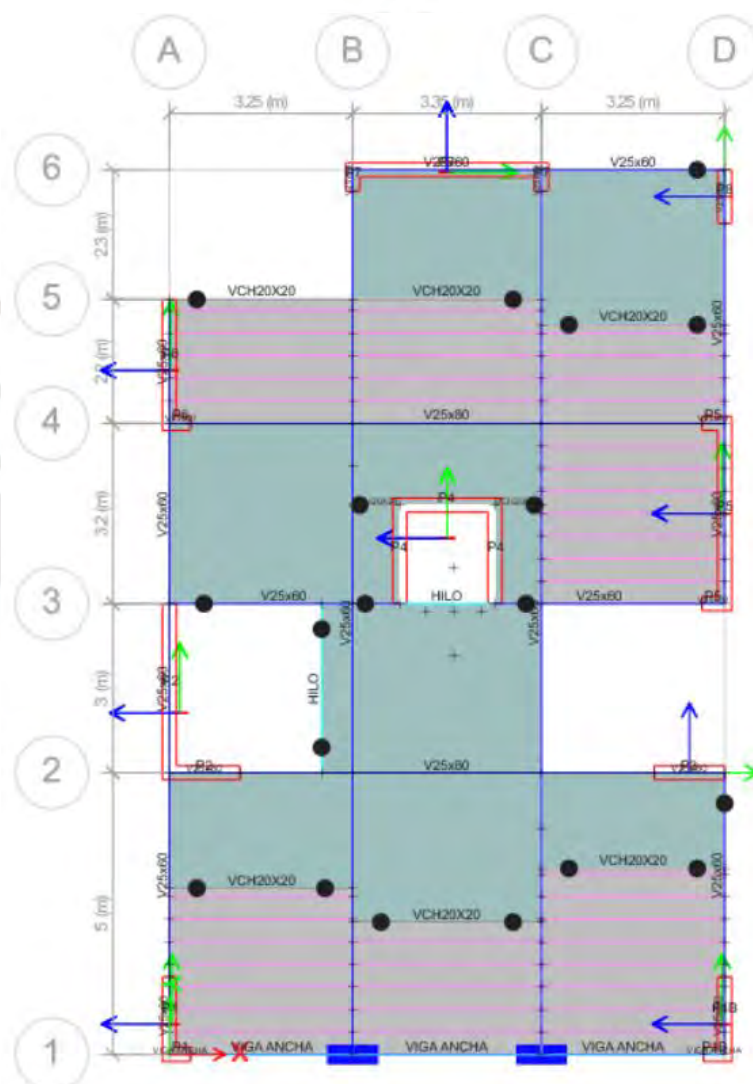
Modelo estructural de losa típica. Fuente: Propia.
